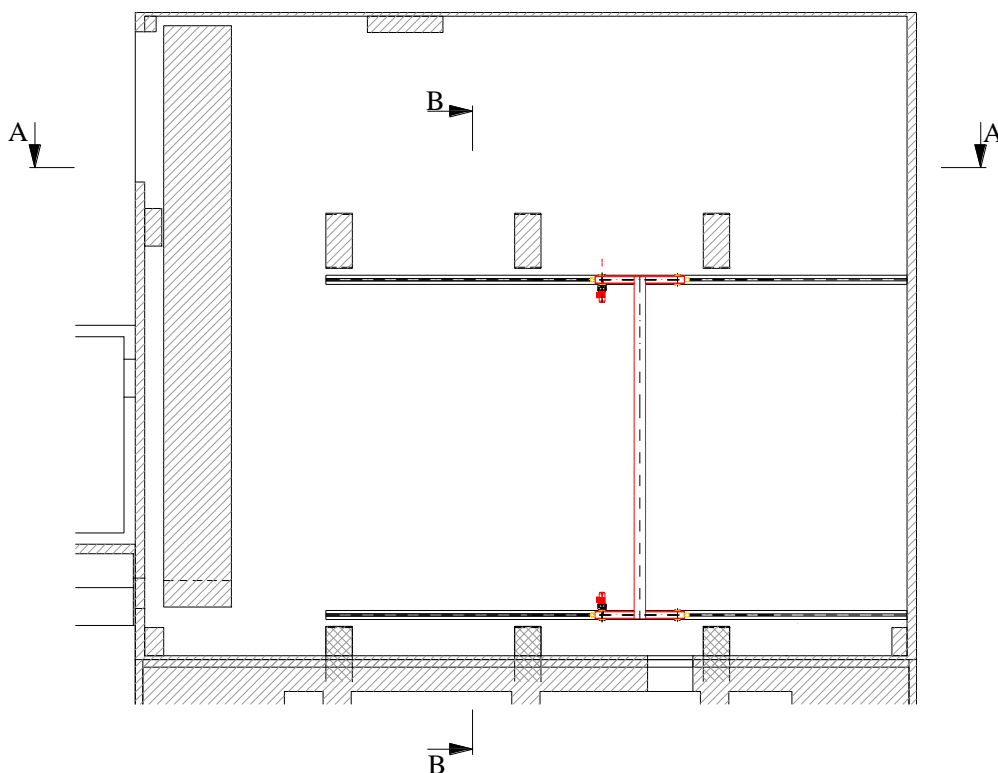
Pianta della Hall RSA-1 livello -1 interessata dall'installazione del carroponte da 5t
